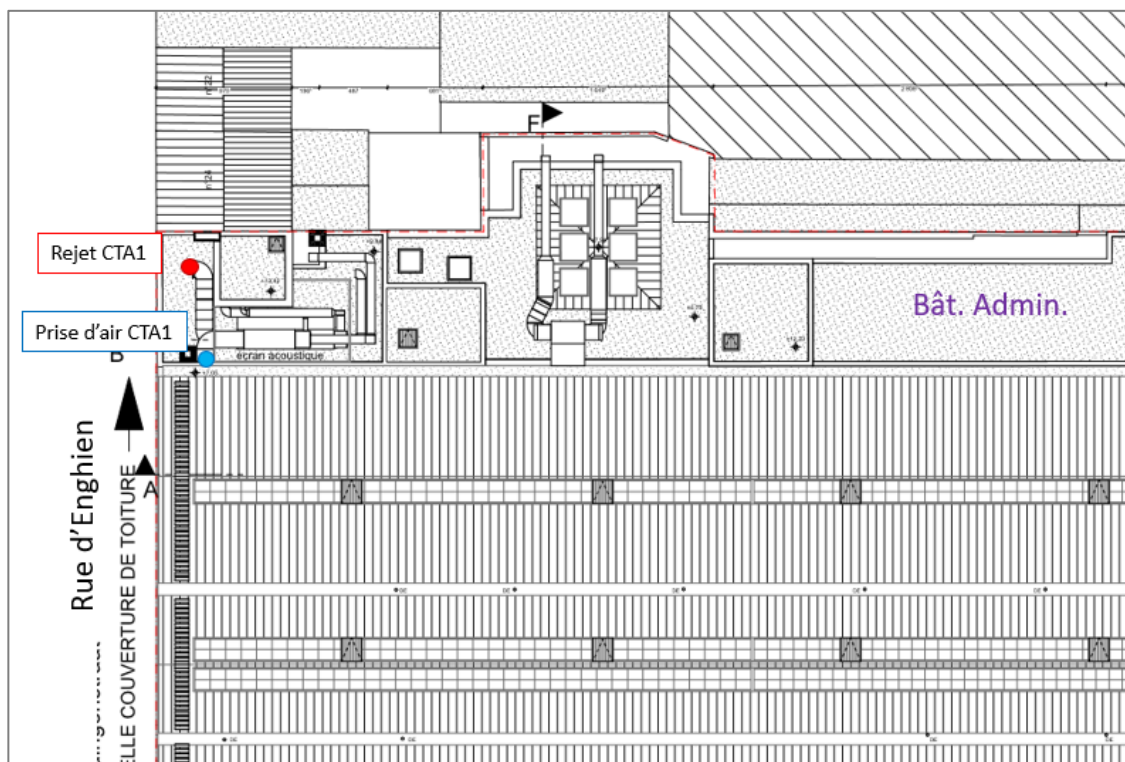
Localisation de la prise et rejet d'air de la CTA1 (source : Architecte)
